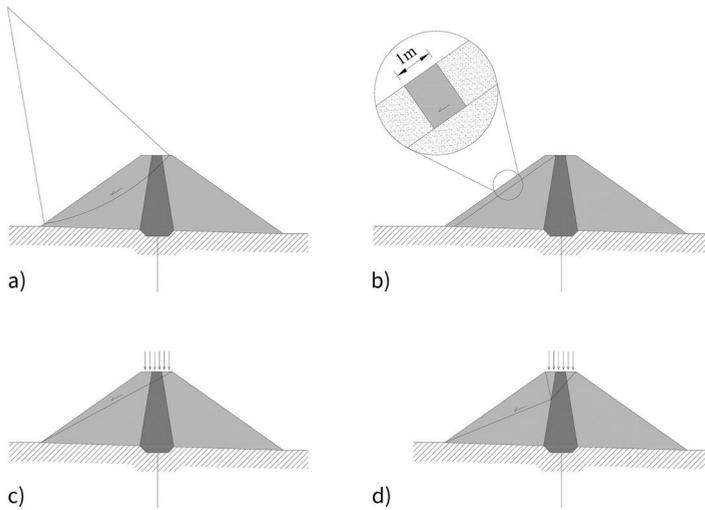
Beispiele für das Versagen durch Böschungsbruchmechanismen (nach [29]);
